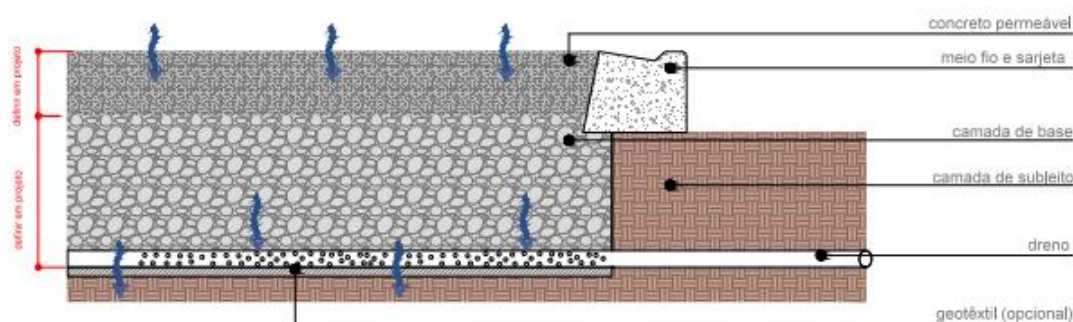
Pavimento com aplicação de concreto permeável com infiltração parcial no solo
